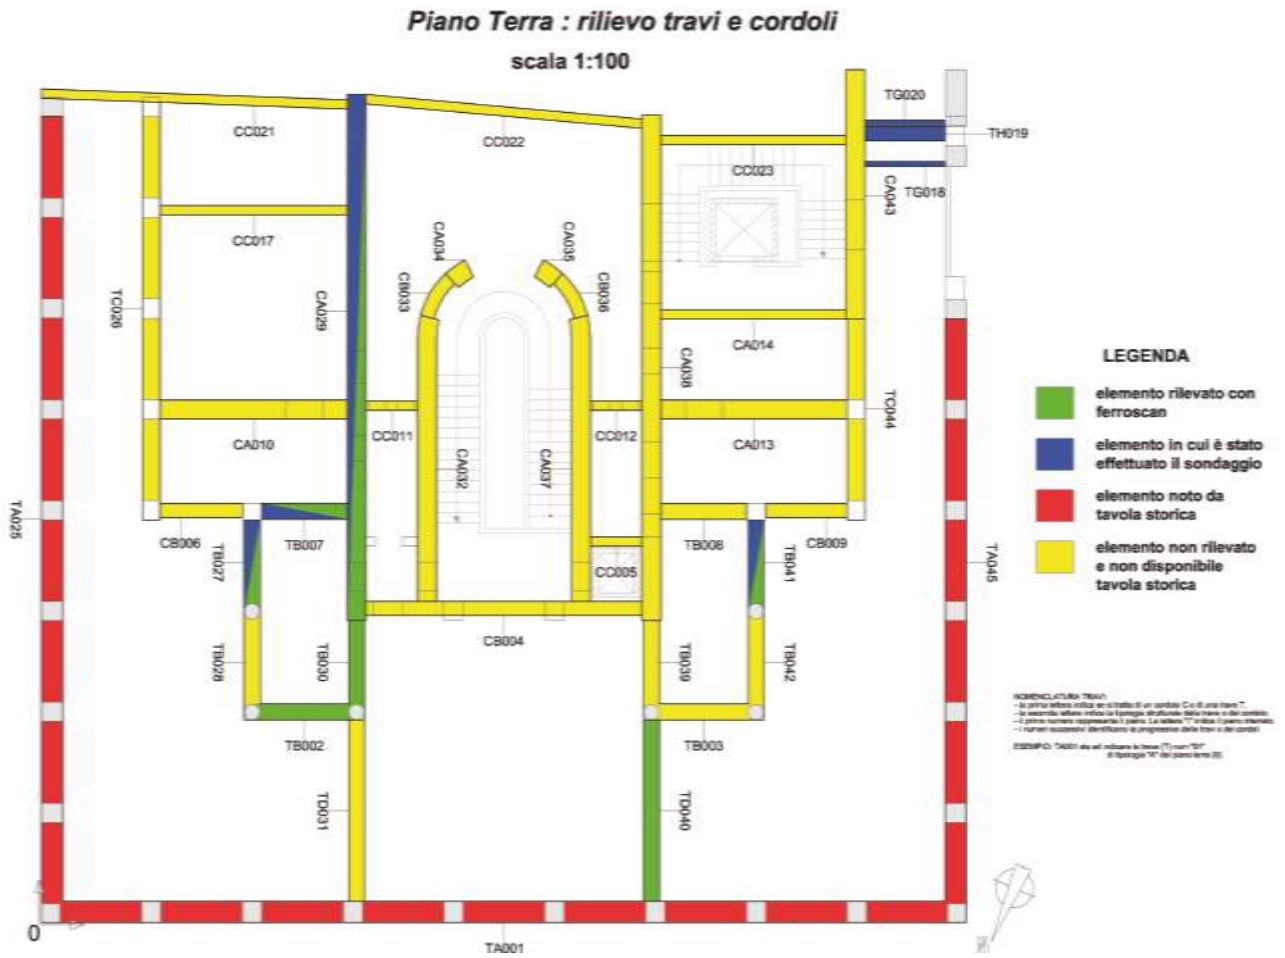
Pianta con indicazione della nomenclatura adottata per le travi del piano terra.
